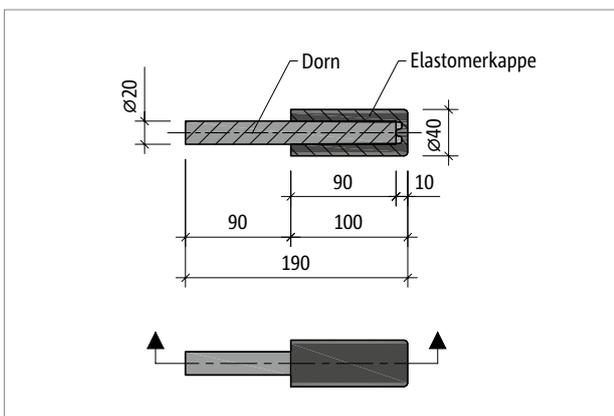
Schöck Tronsole® Typ D: Produktgrundriss
